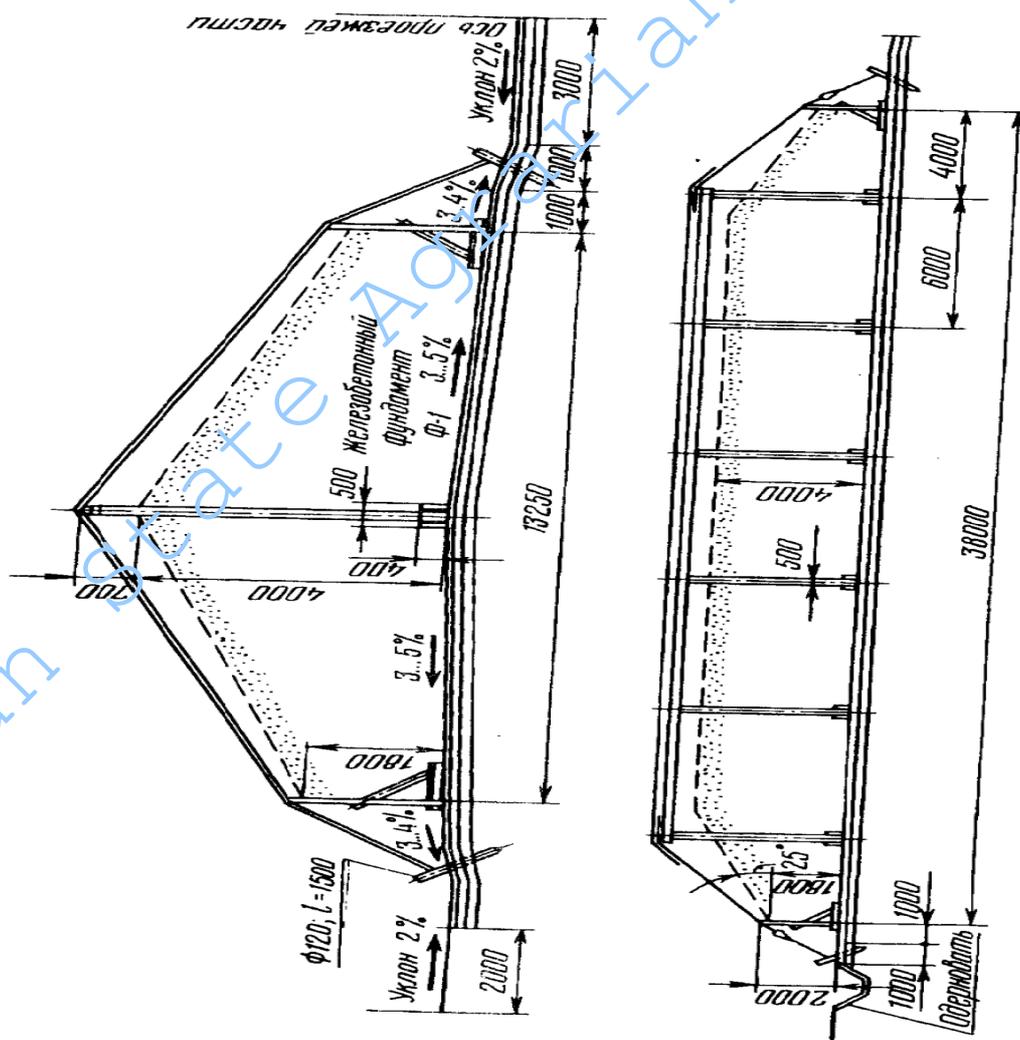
Поперечный и продольный разрезы асфальтированной площадки I типа (со стойками для крепления брезента)
